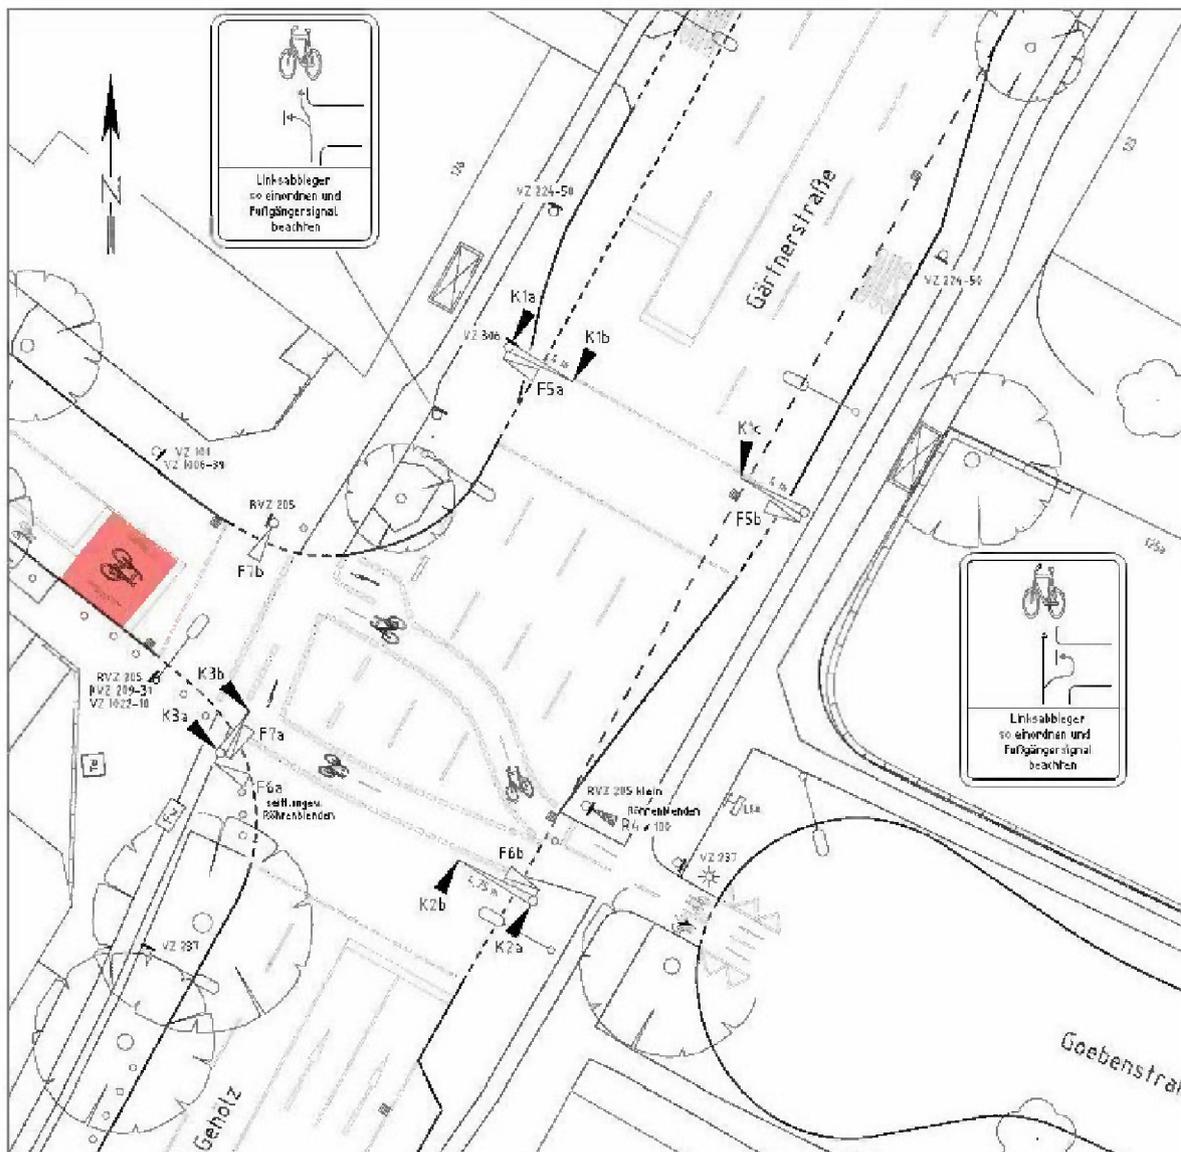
1 Signallageplanausschnitt LSA 1315
